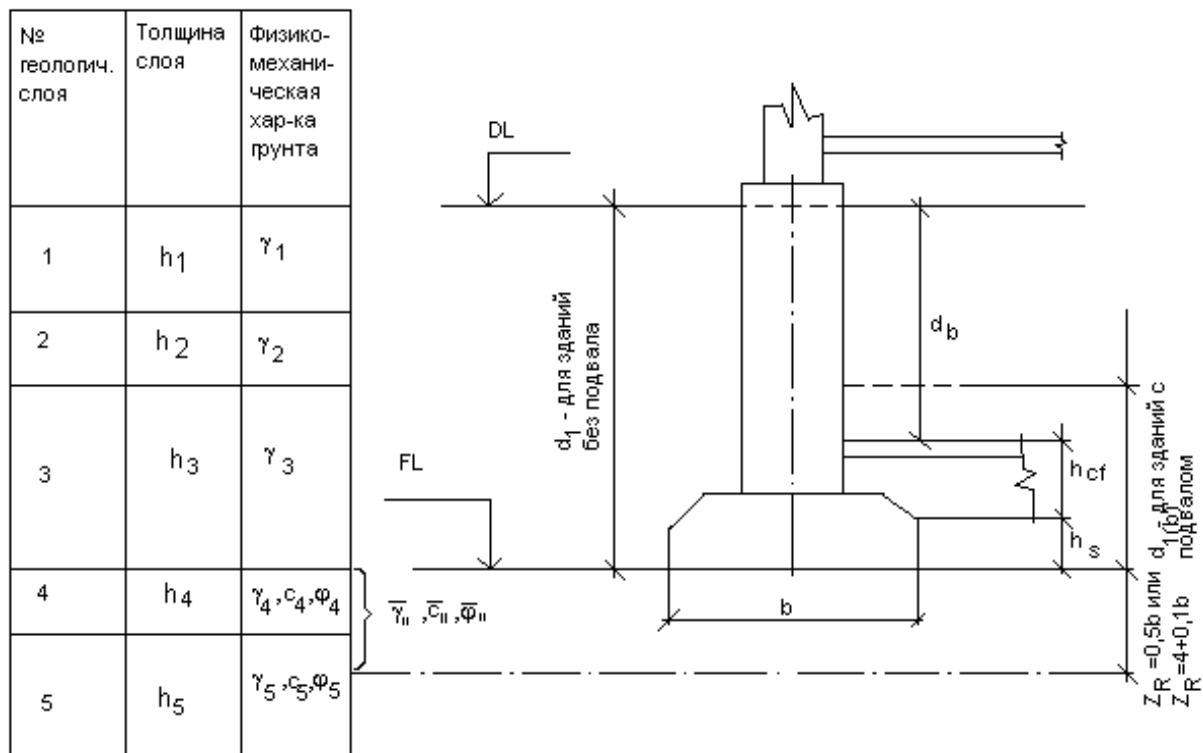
Схема к определению расчетного сопротивления грунта
